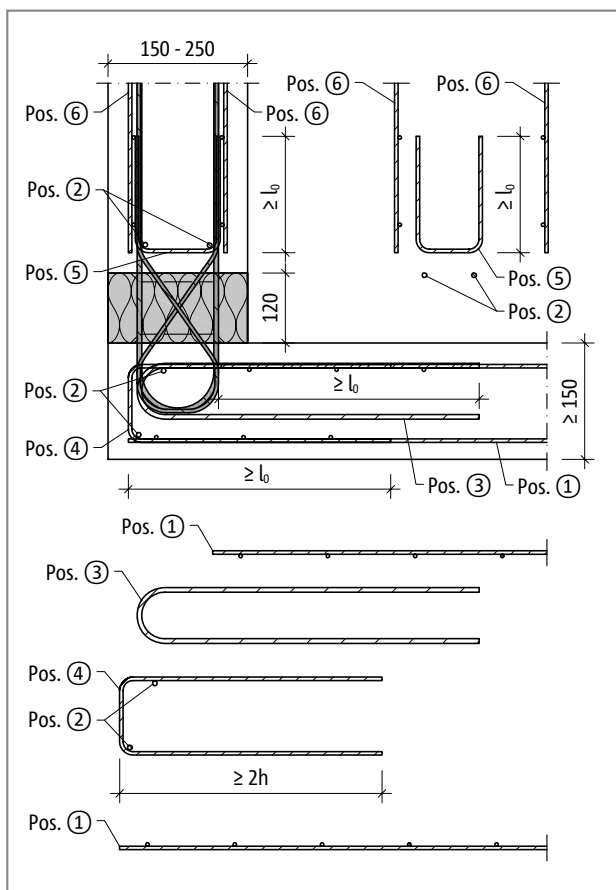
Schöck Isokorb® tipo ABXT - disposizione verticale, armatura in opera
